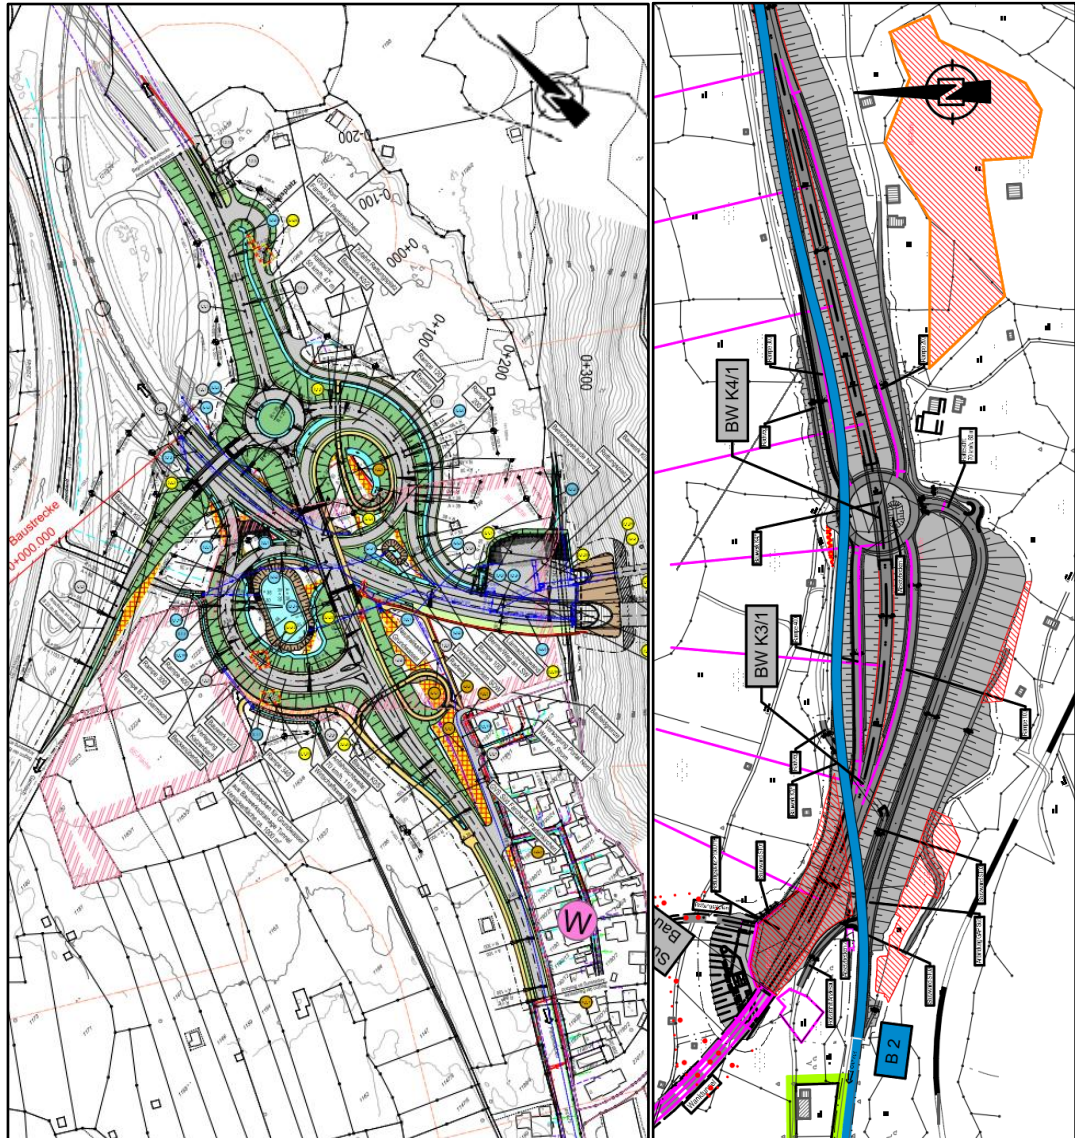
Lageplan der Baustelleneinrichtungsflächen Nord (links) und Süd (rechts) [1]
